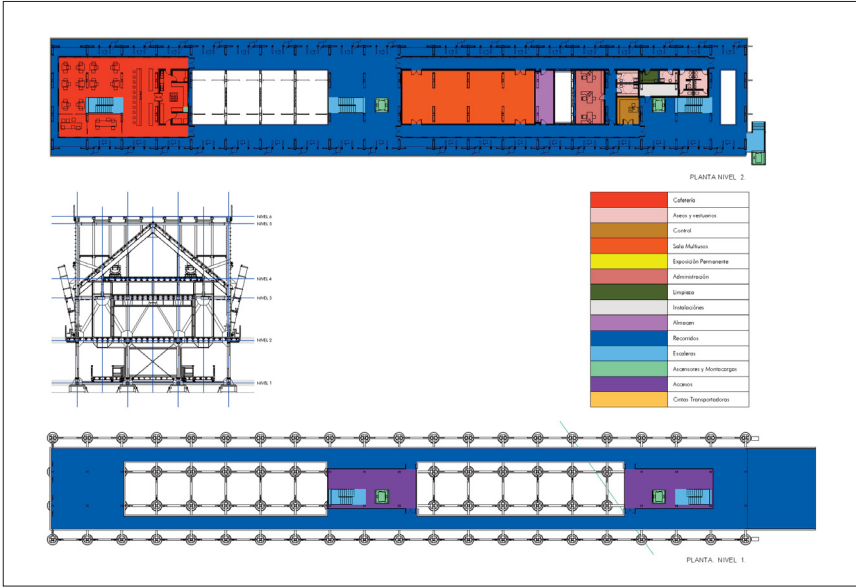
Plantas niveles 1-2, Almería, 2009. Elaboración propia.
